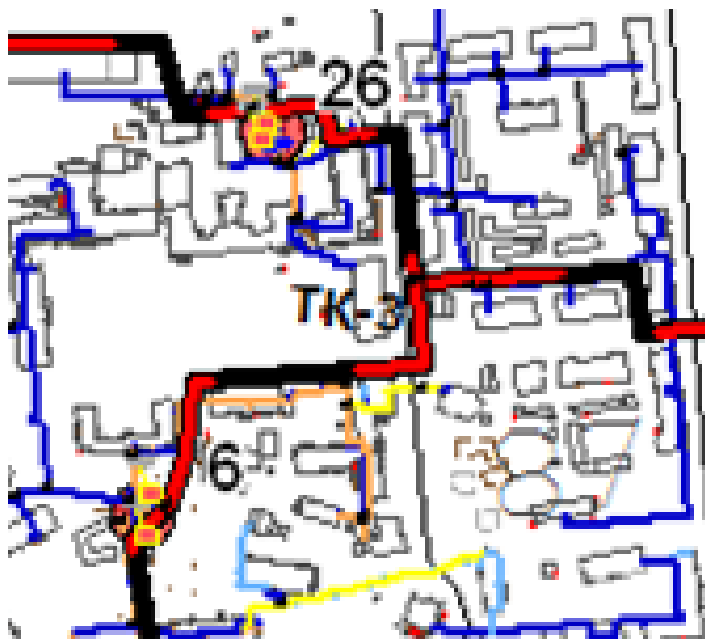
Схема прокладки трубопровода между котельными №6 и №26
